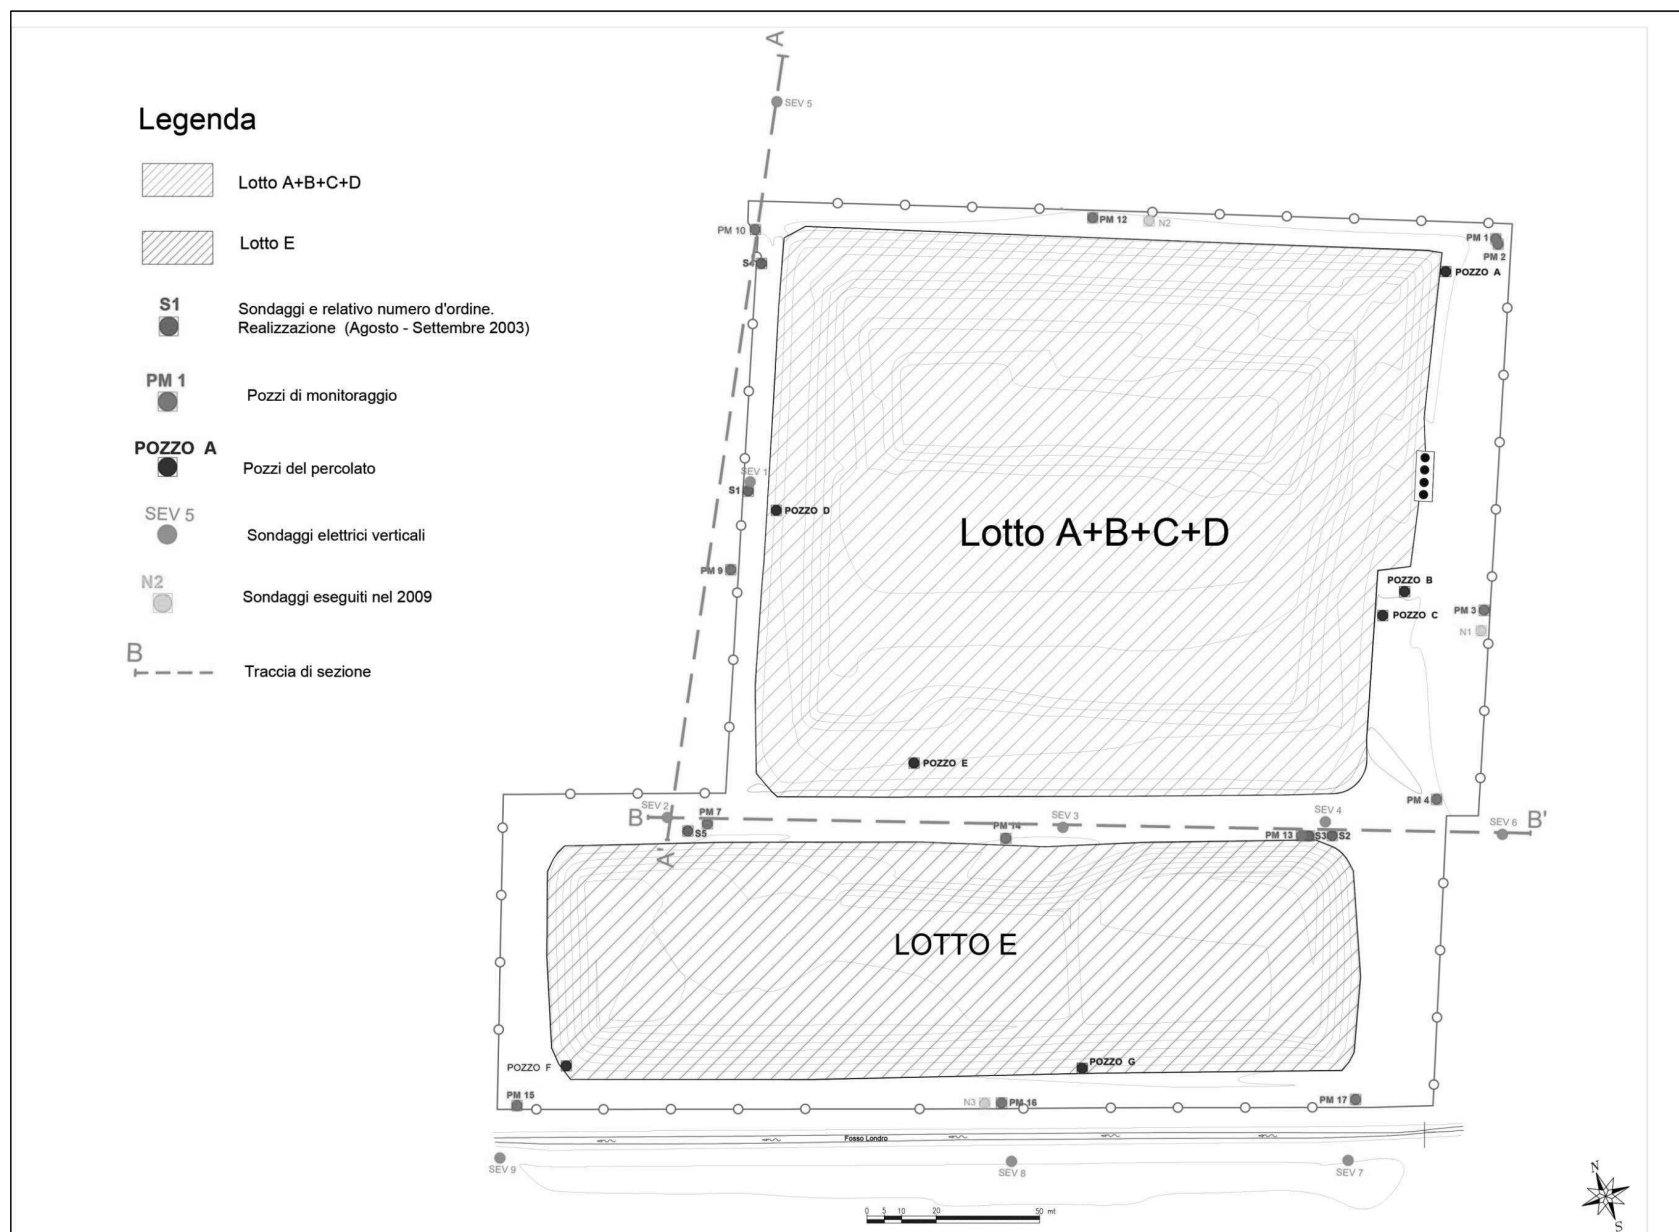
planimetria con ubicazioni indagini e traccia di sezione
